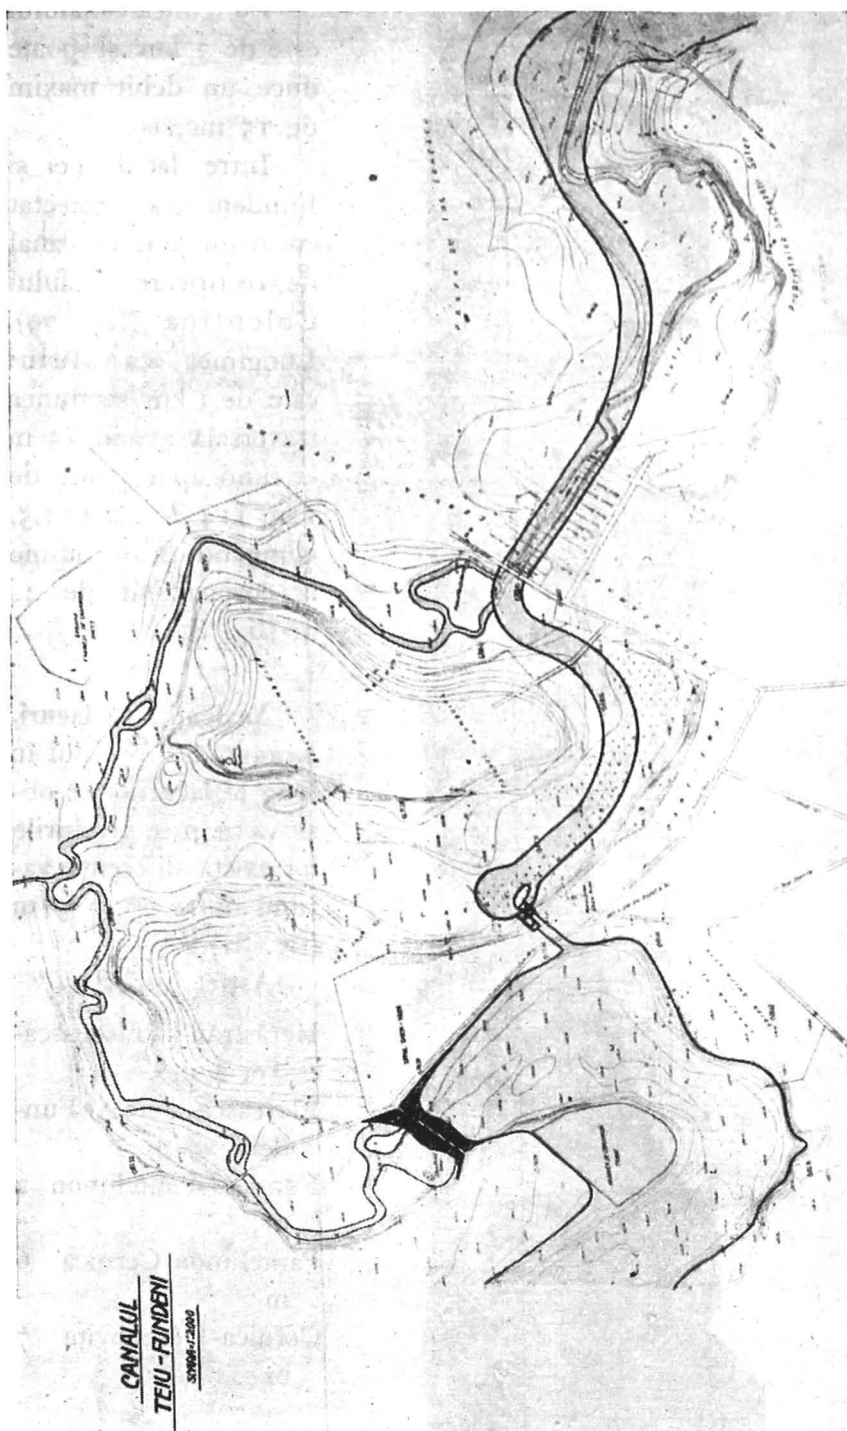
Plan de situație al canalului Tei-Fundeni.
